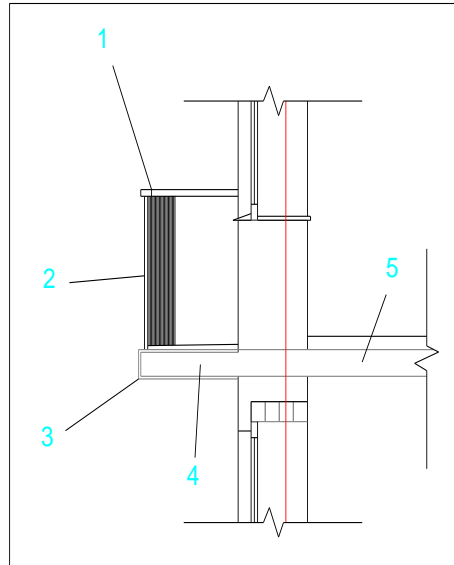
Фрагмент конструктивного рішення балкону: 1-пластиковий парпет; 2-металева огорожа; 3-утеплювач; 4-балконна плита; 5-плита перекриття.
